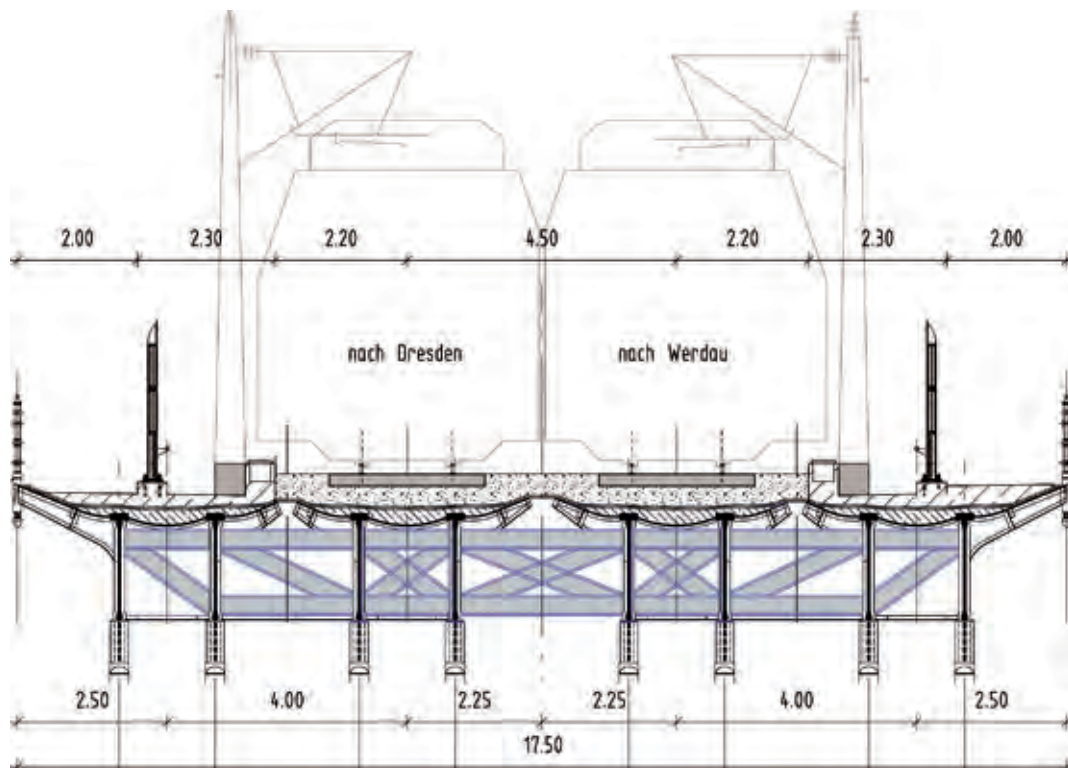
Brückenträger mit quer verlaufendem Fachwerkträger (Prinzipdarstellung)
